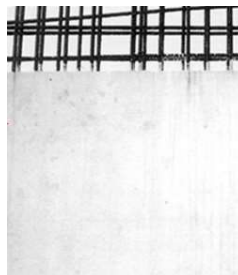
Armaduras oxidadas, antes da betonagem [5]
